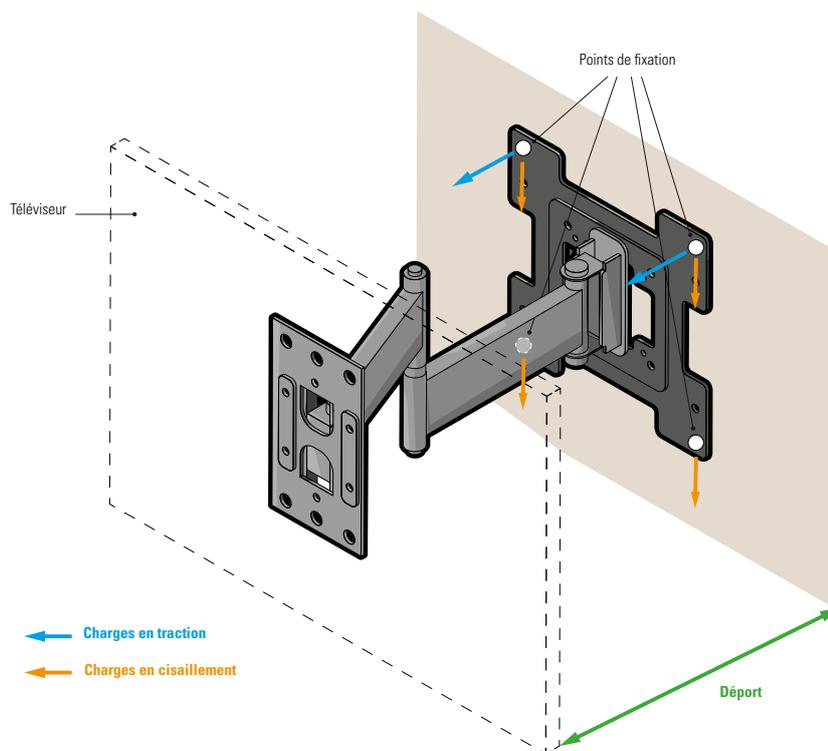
exemple de fixation d'un téléviseur avec bras articulé et platine avec fixation rapprochée
